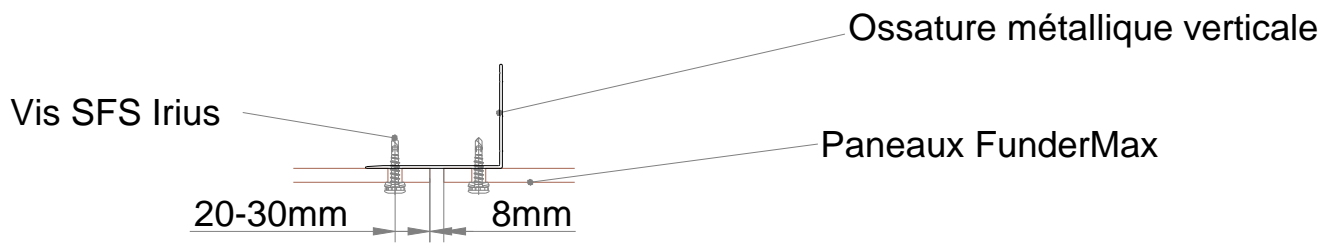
Joint vertical à la jonction de panneaux en bardage rapporté ventilé
